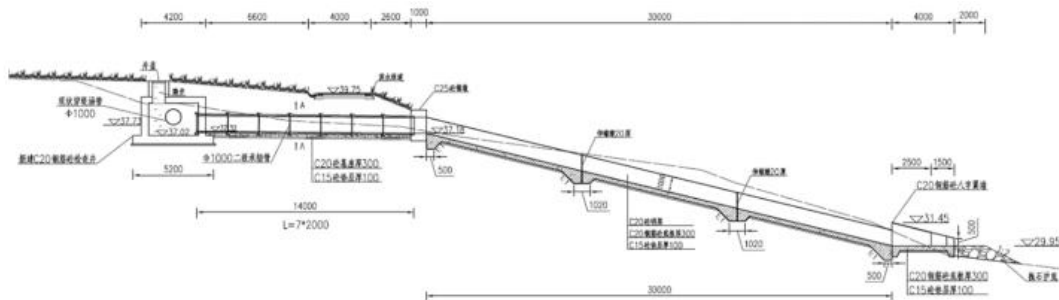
芙蓉北路排水涵改造纵剖面图
